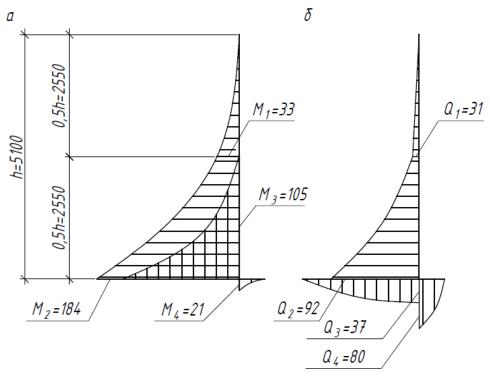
Эпюры внутренних усилий в элементах уголковой подпорной стены: a- эпюра моментов, $\frac{\kappa H \cdot M}{M}$; 6- эпюра поперечных сил, $\frac{\kappa H}{M}$.
